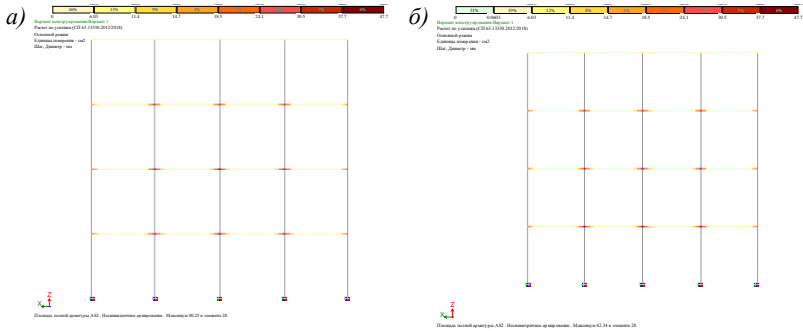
Расчетная площадь нижней продольной арматуры: а – для 1-го варианта нагружения (вертикальная сила и кручение); б – для 2-го варианта нагружения (только вертикальная сила)
